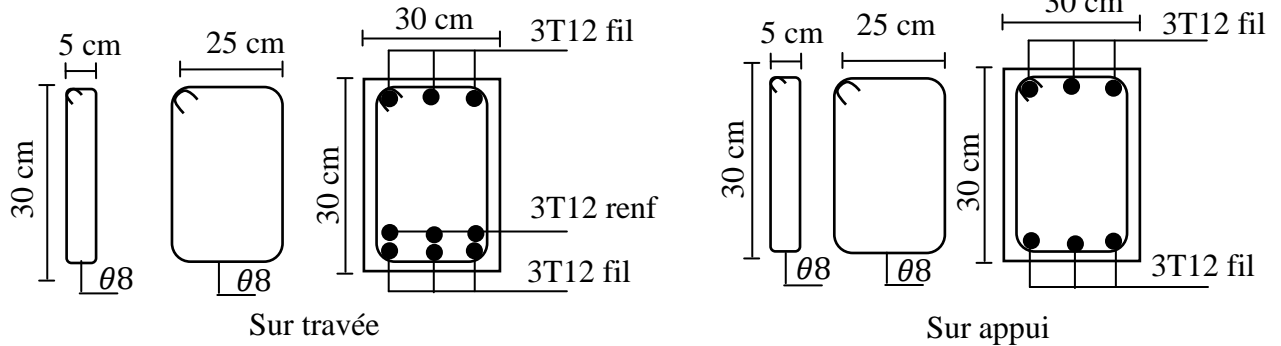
Schéma de ferrailage de la poutre palière.
